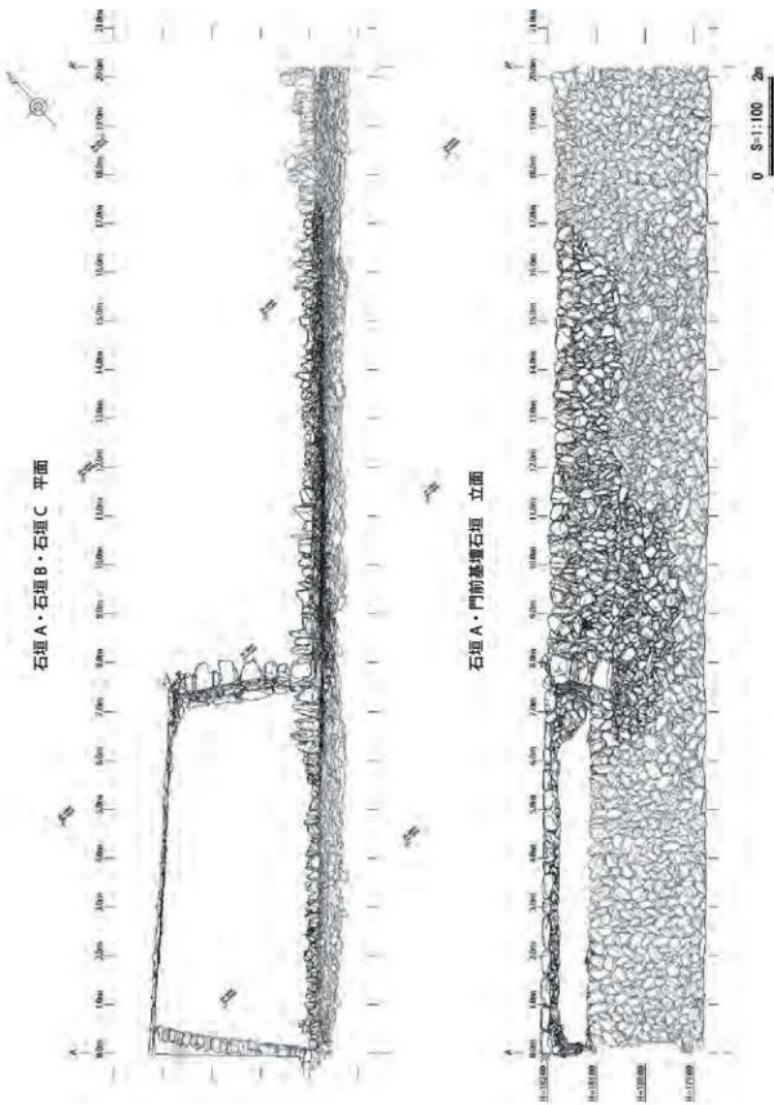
石垣 A・石垣 B・石垣 C 平面・立面図
